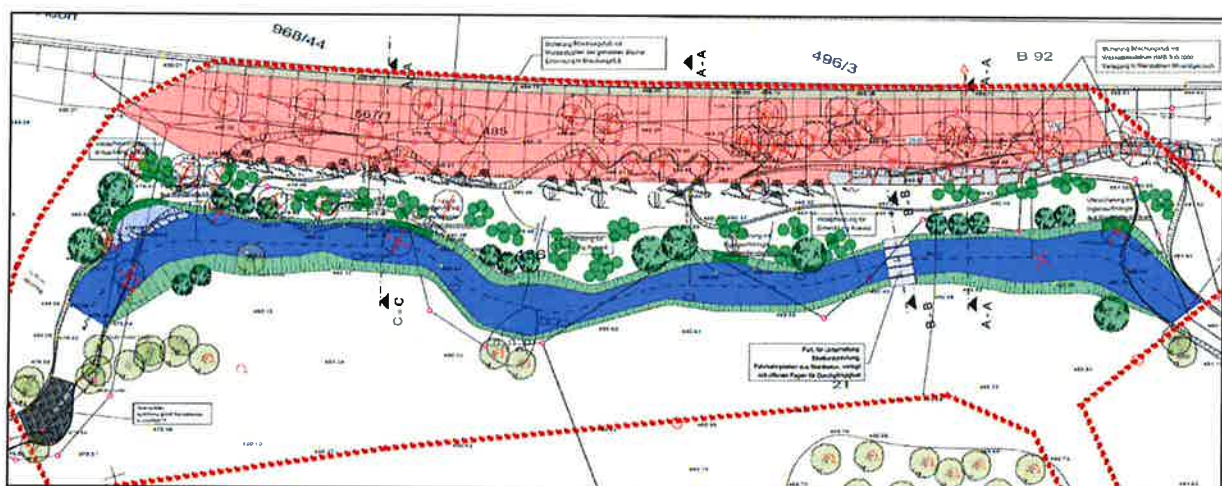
Ausschnitt Lageplan Baubereich mit bestehendem (keine Farbe) und neuem Bachverlauf (blau) (aus [Anlage 5.1](#), [\[LAS-21\]](#))
